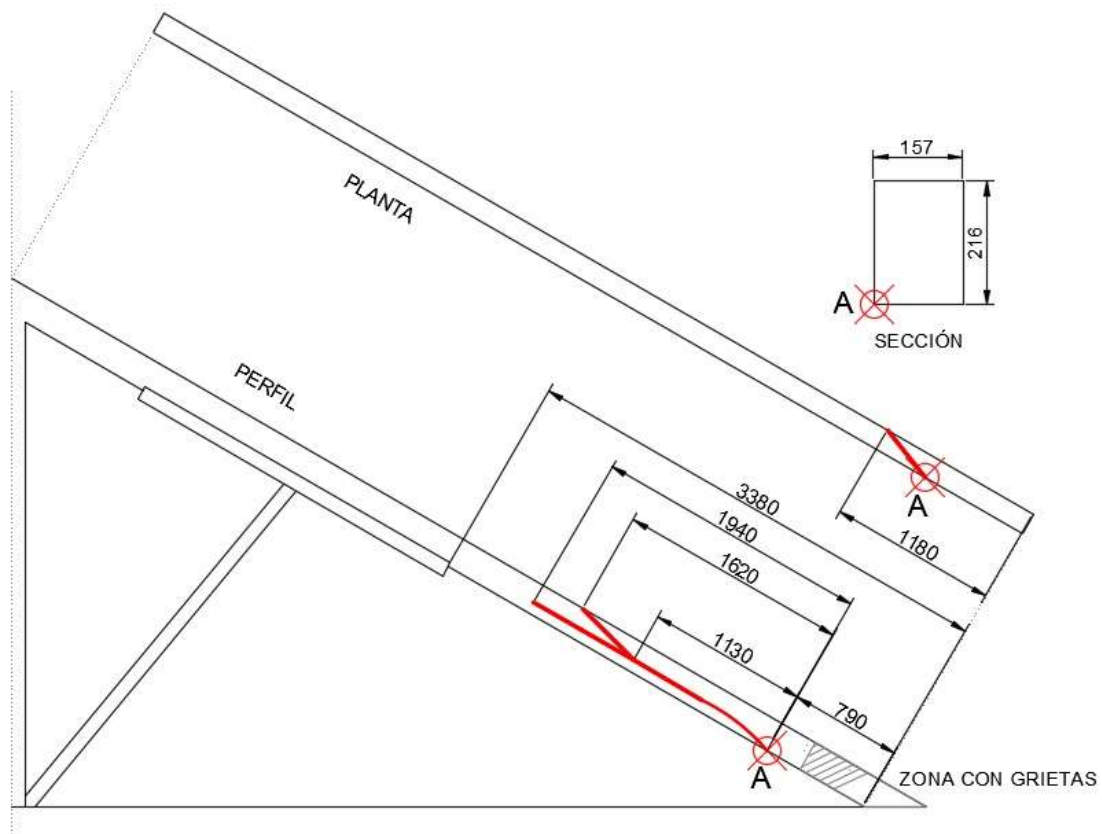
Croquis de situación de partida de la viga. Línea roja: grieta de rotura. Cotas en mm.
